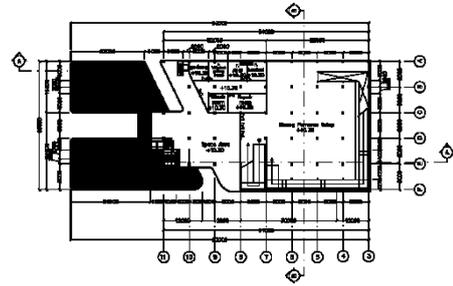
Denah Lantai 1 (Sumber: analisa penulis).
